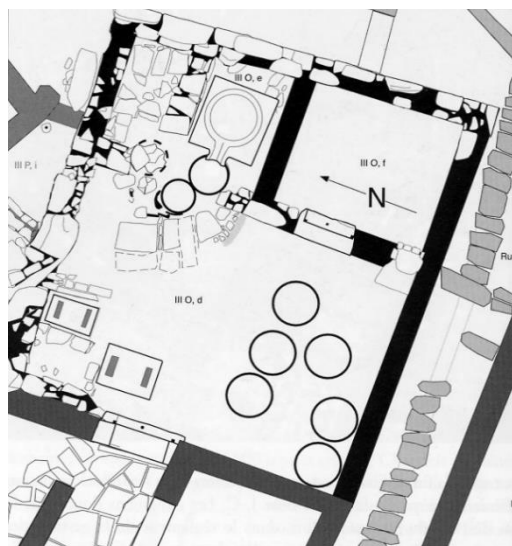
Alzado de la almazara de Delos, Grecia. Brun y Brunet, 1997.
